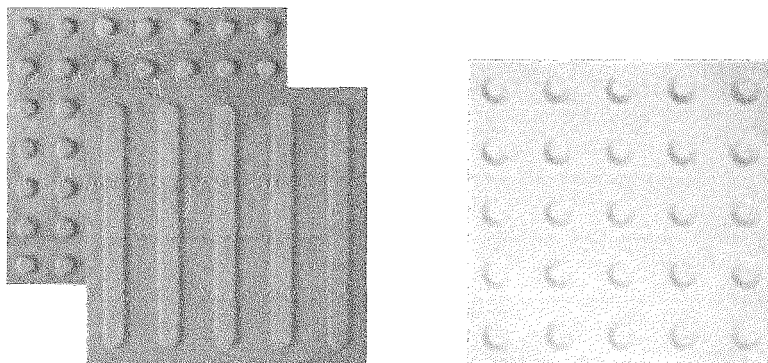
imagens exemplificativas de piso tátil de concreto – Cores: vermelha e amarelo
